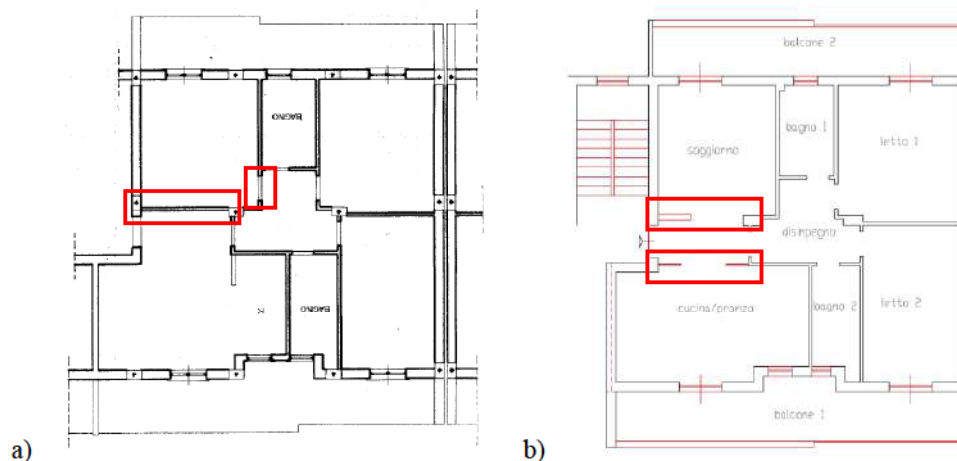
Difformità appartamento: a) Planimetria del titolo autorizzativo; b) Planimetria stato di fatto
